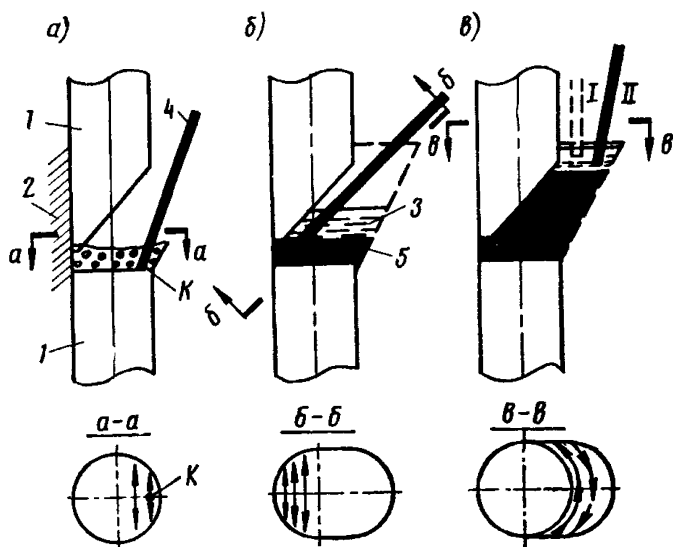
Техника полуавтоматической ванной дуговой сварки стыковых соединений вертикальных стержней диаметром ≤ 32 мм
